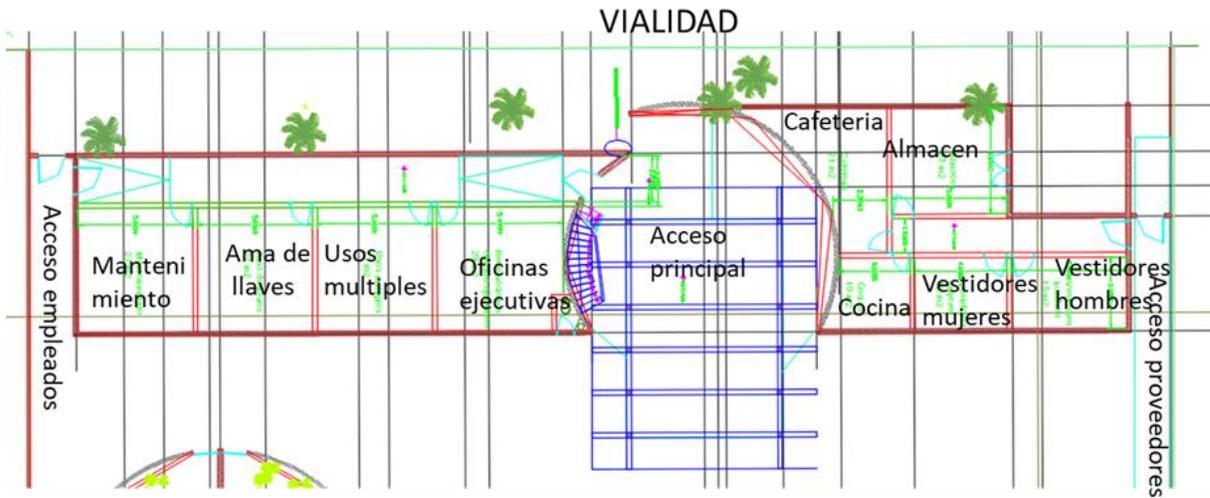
EDIFICIO YUMA PLANTA ALTA
